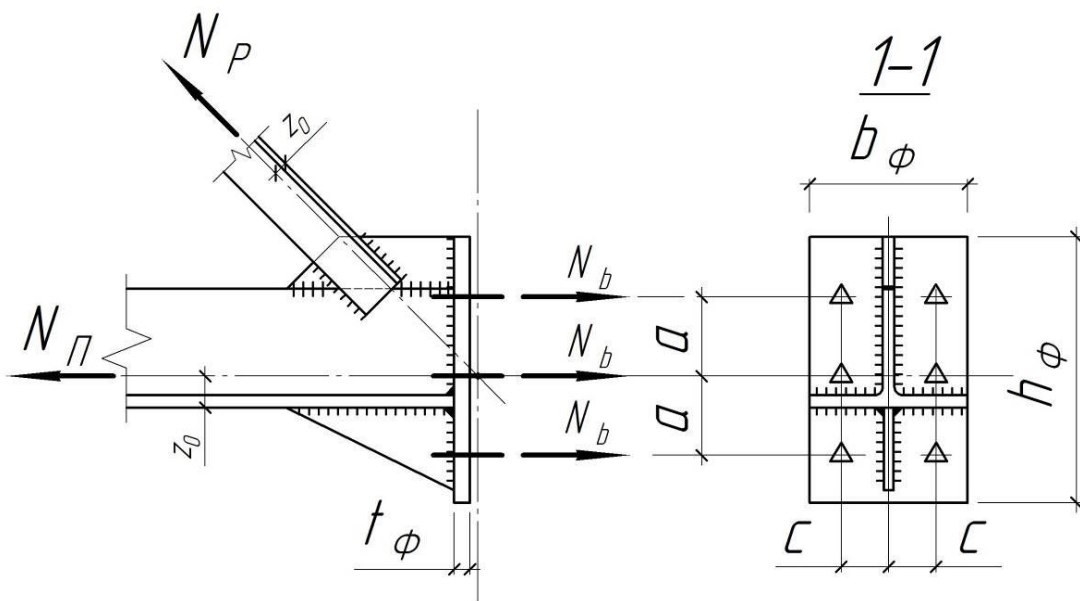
Розрахункова схема фланцевого монтажної вузла ферми
